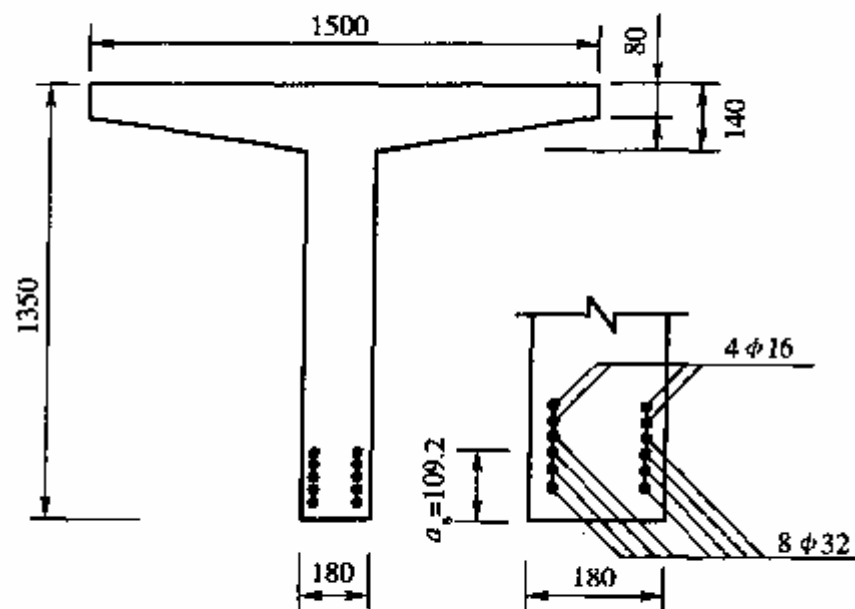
T 梁截面尺寸及配筋图(尺寸单位:mm)
